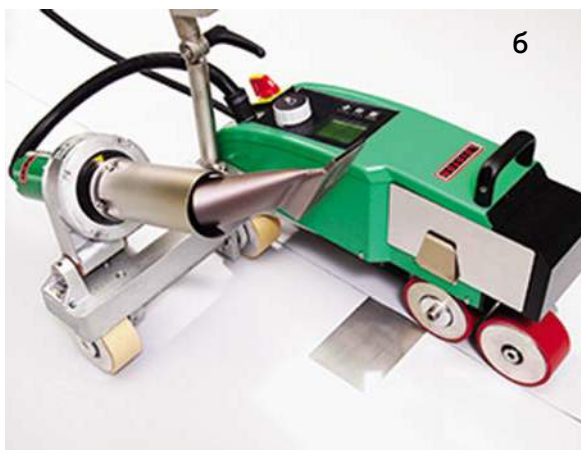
Автоматическое сварочное оборудование
